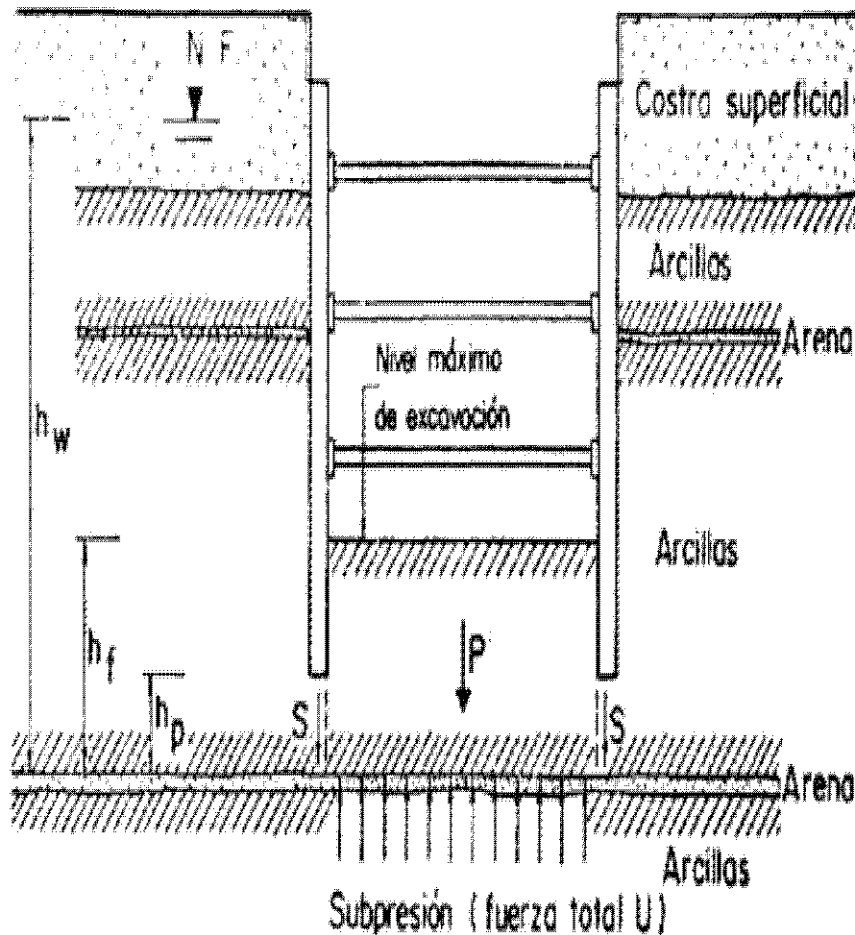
Mecanismo de falla de fondo por subpresión (covitur)
